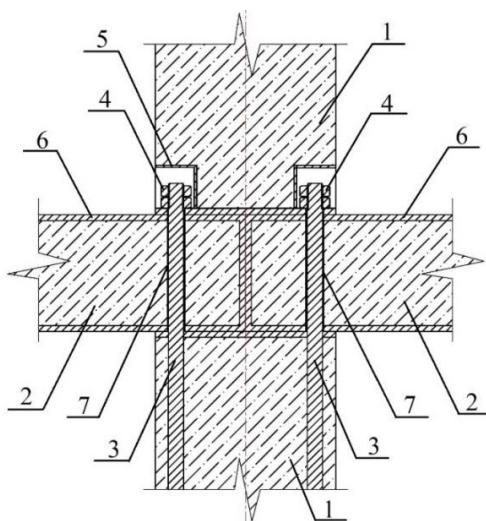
Узел сопряжения плит перекрытия и колонн:
